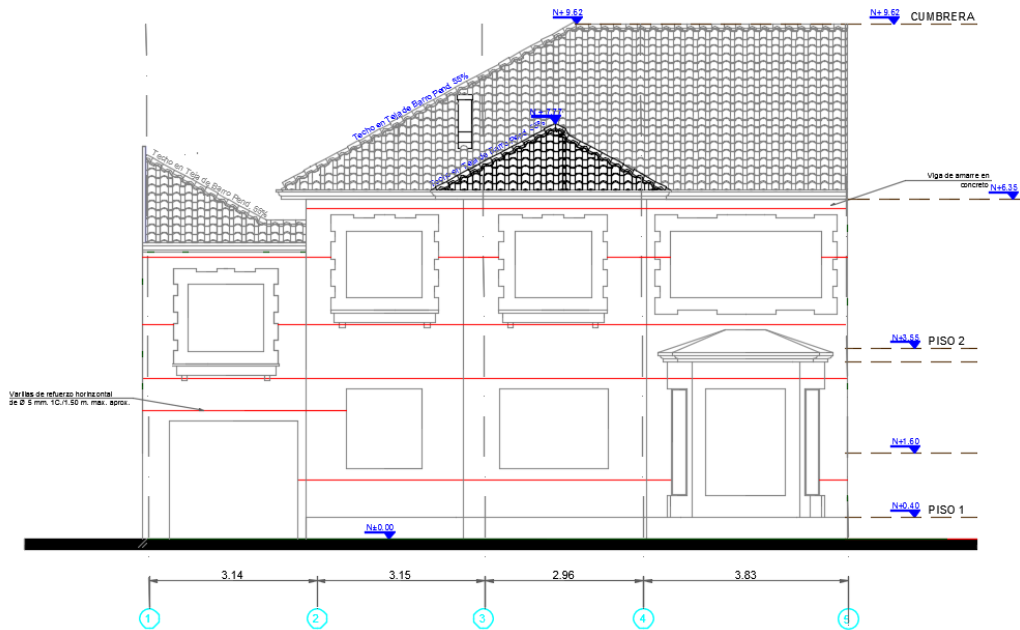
Distribución de las varillas de acero en la fachada principal de la casa ubicada en la carrera 18 # 34-15. Fuente: Planos de reforzamiento elaborados por el Ing. Manuel Antonio Ramirez Vargas
